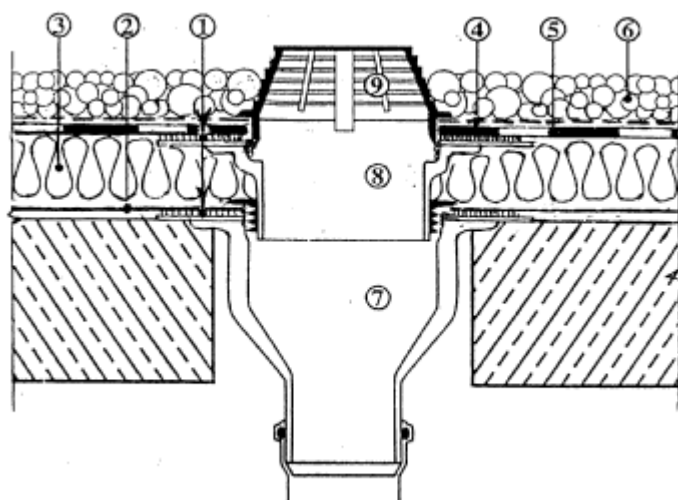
Примыкание неэксплуатируемой кровли к водосточной воронке
